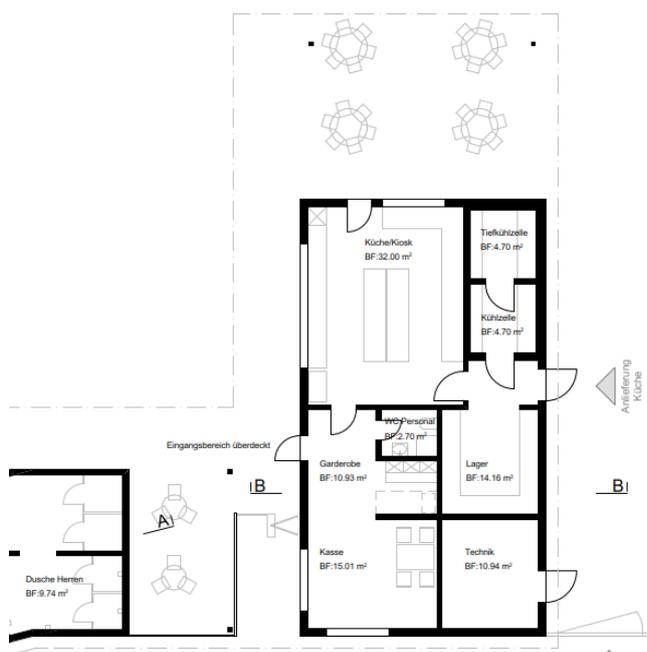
Ausschnitt Grundriss Eingangs- und Gastrobereich
